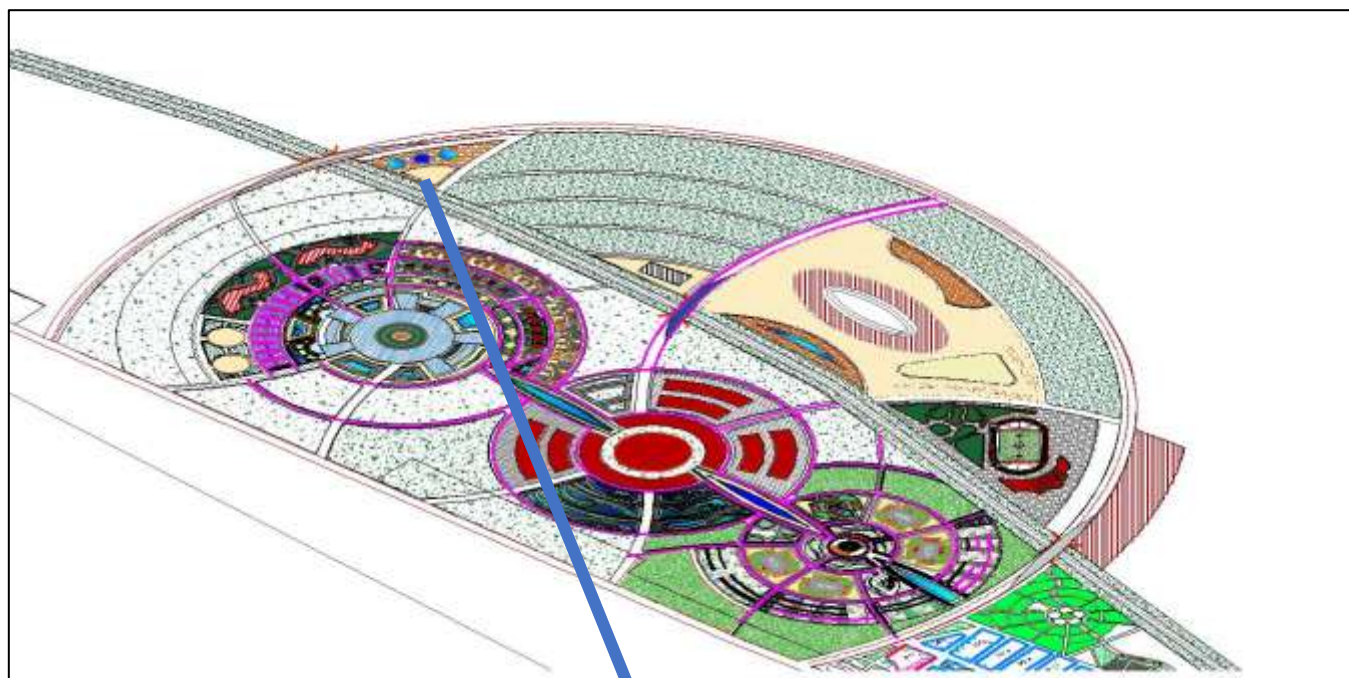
la projection de la station de lagunage sur le plan de masse.
